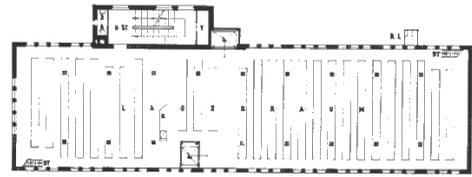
Originalgrundriss Zweiganstalt Favoriten
